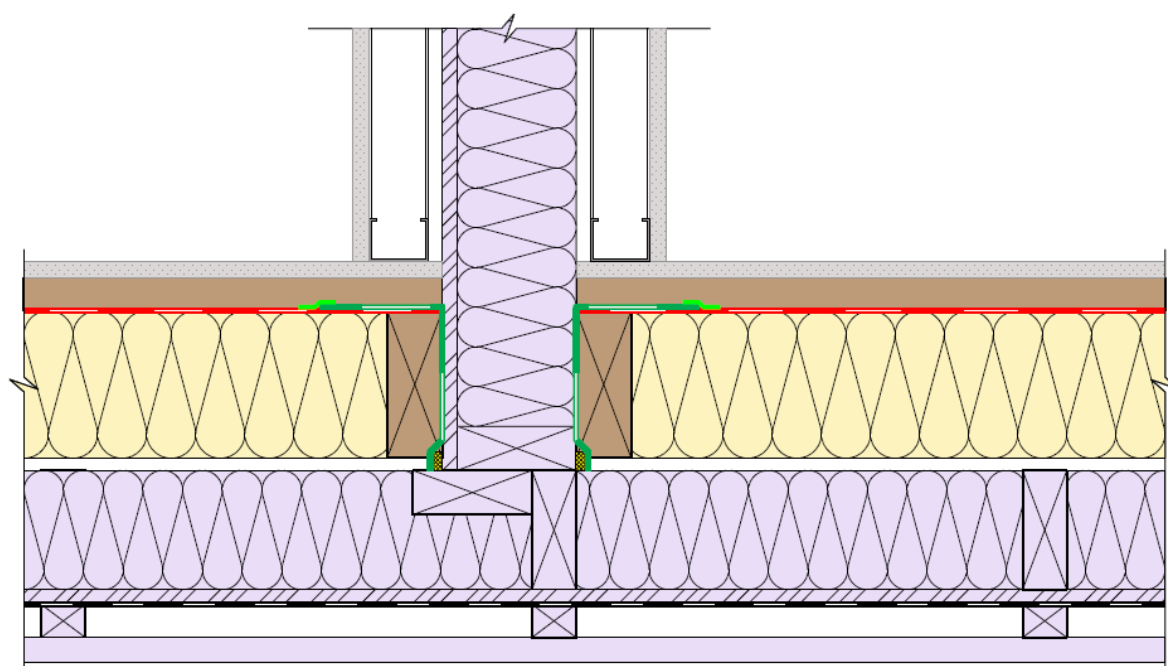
Liaison avec mur intérieur (coupes horizontales)
